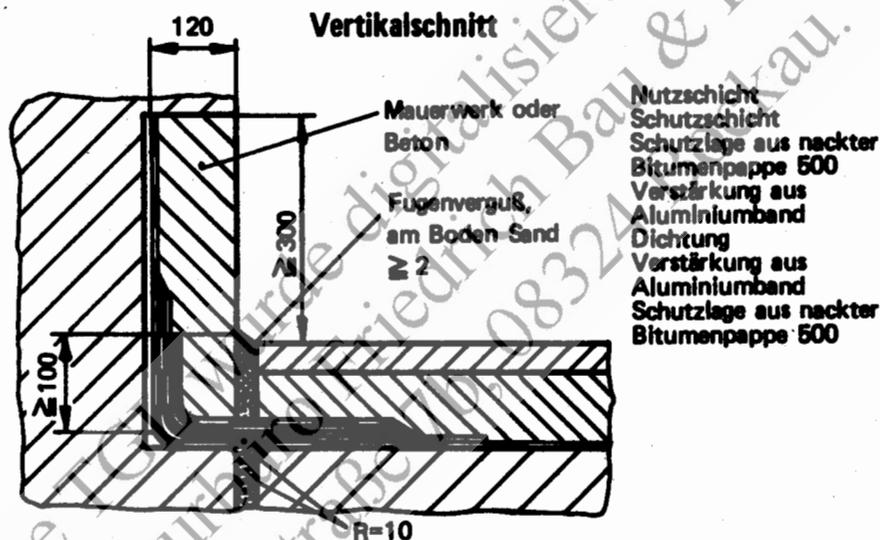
Bewegungsfuge mit ebener Dichtungsverstärkung am Übergang zu einem senkrechten Bauteil
